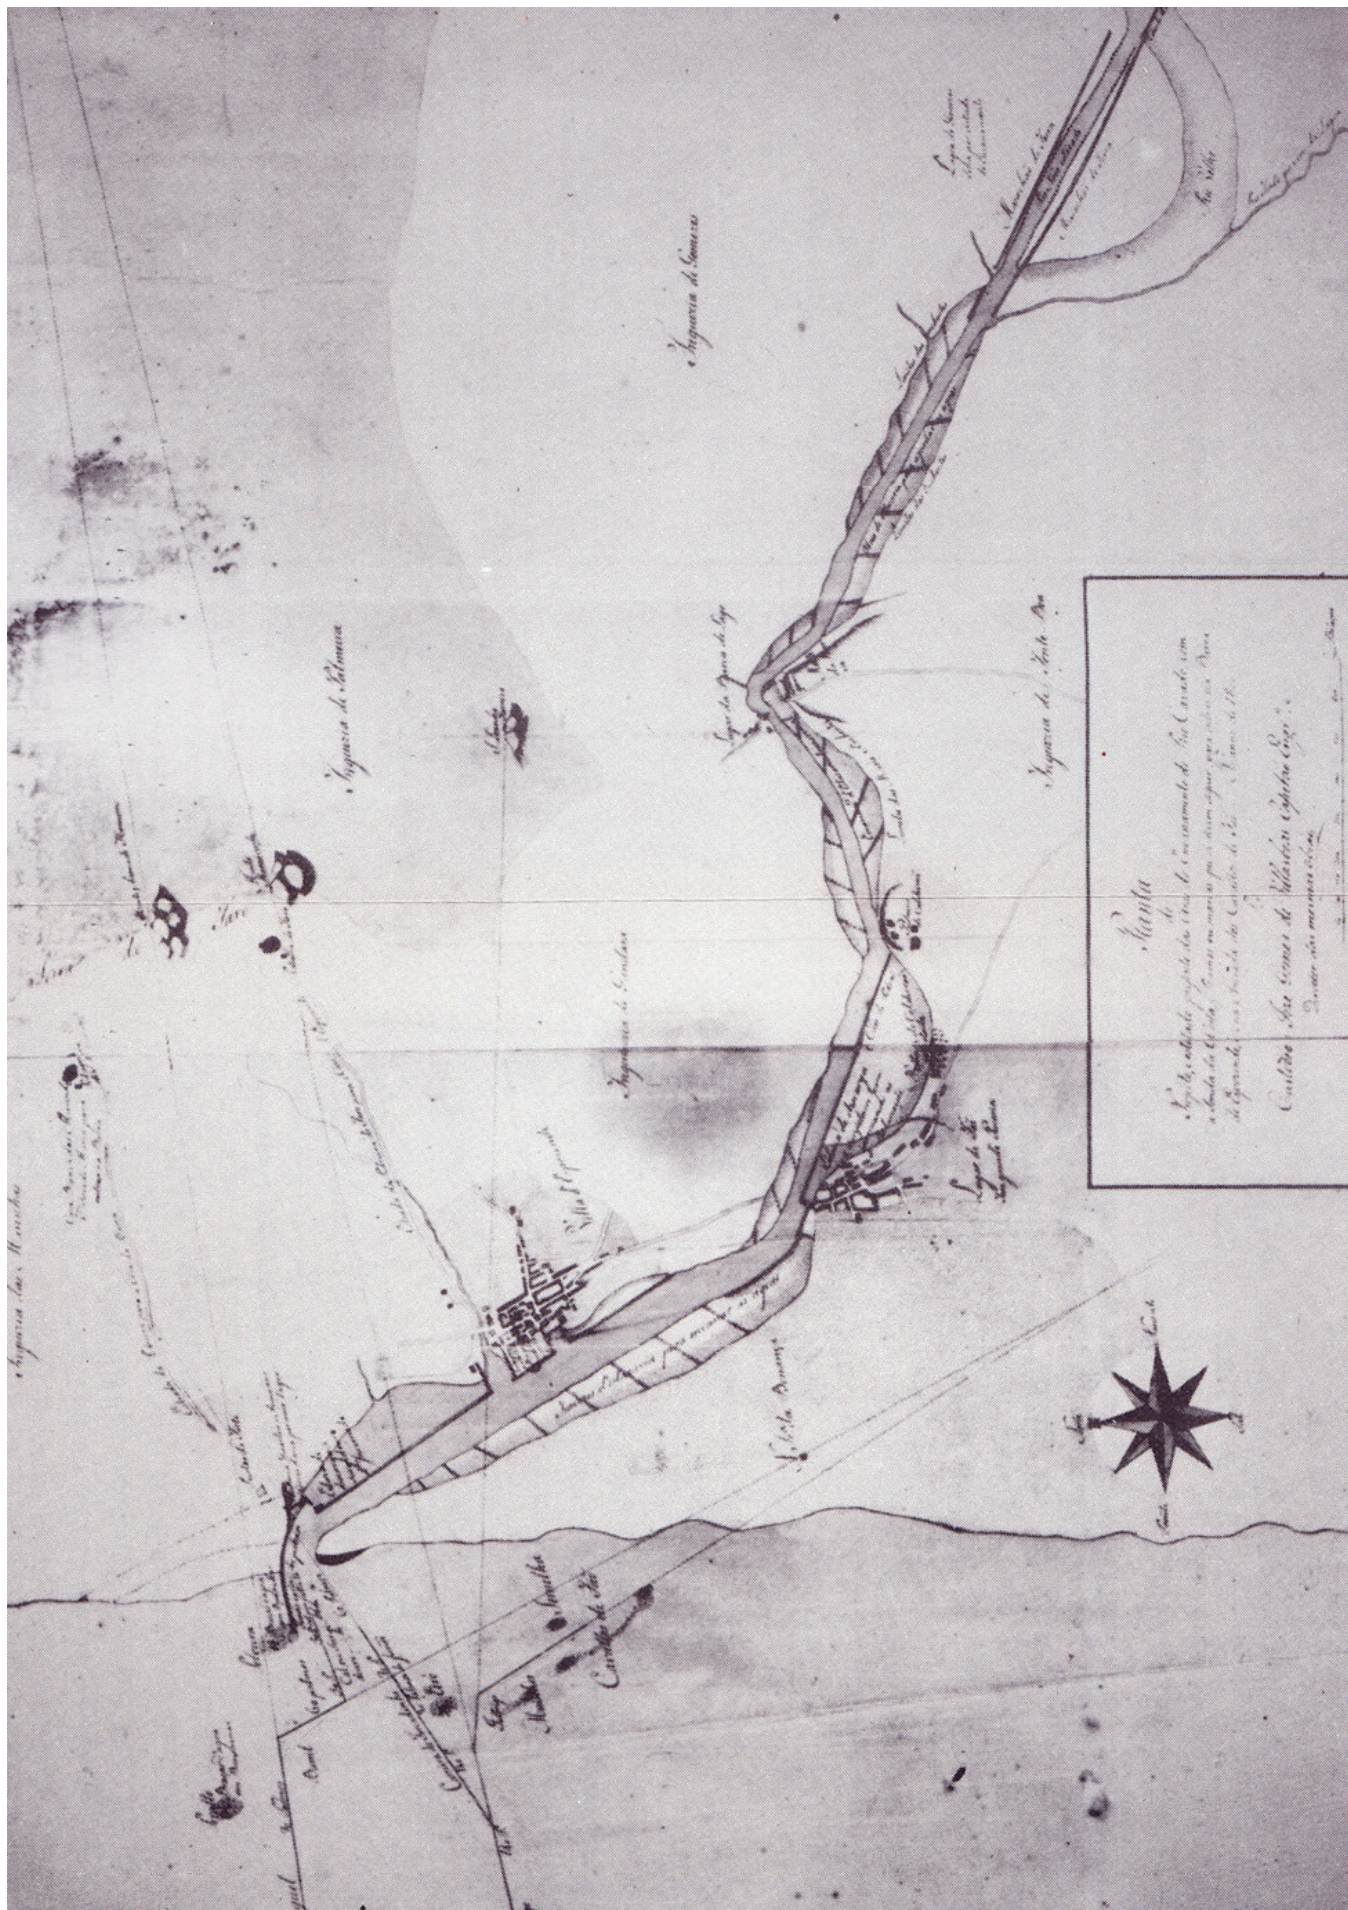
Planta de Encanamento do rio Cávado Engenheiro Custódio de Vilas Boas - 1795
